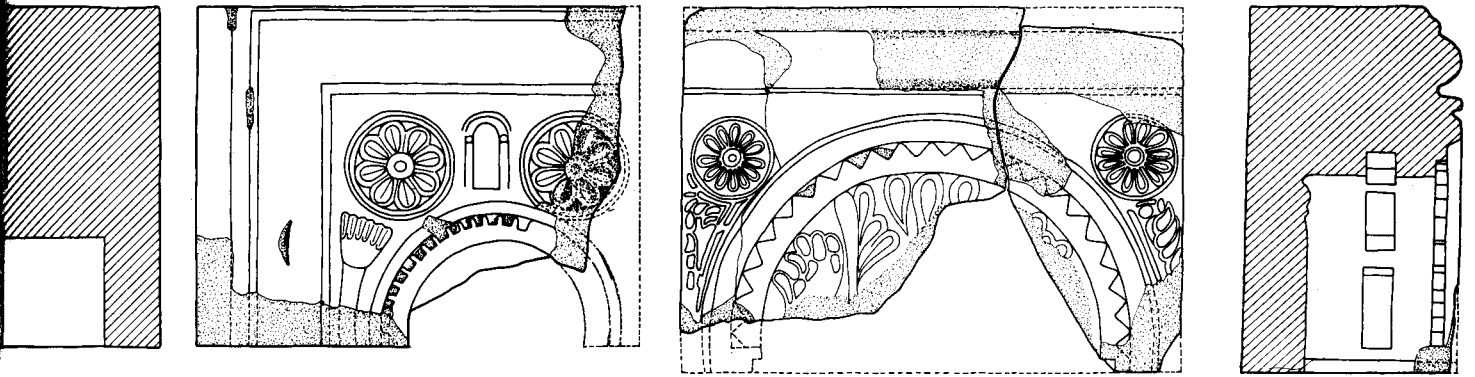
Detalle de los arquillos y pilastras del muro testero del *īwān*.
